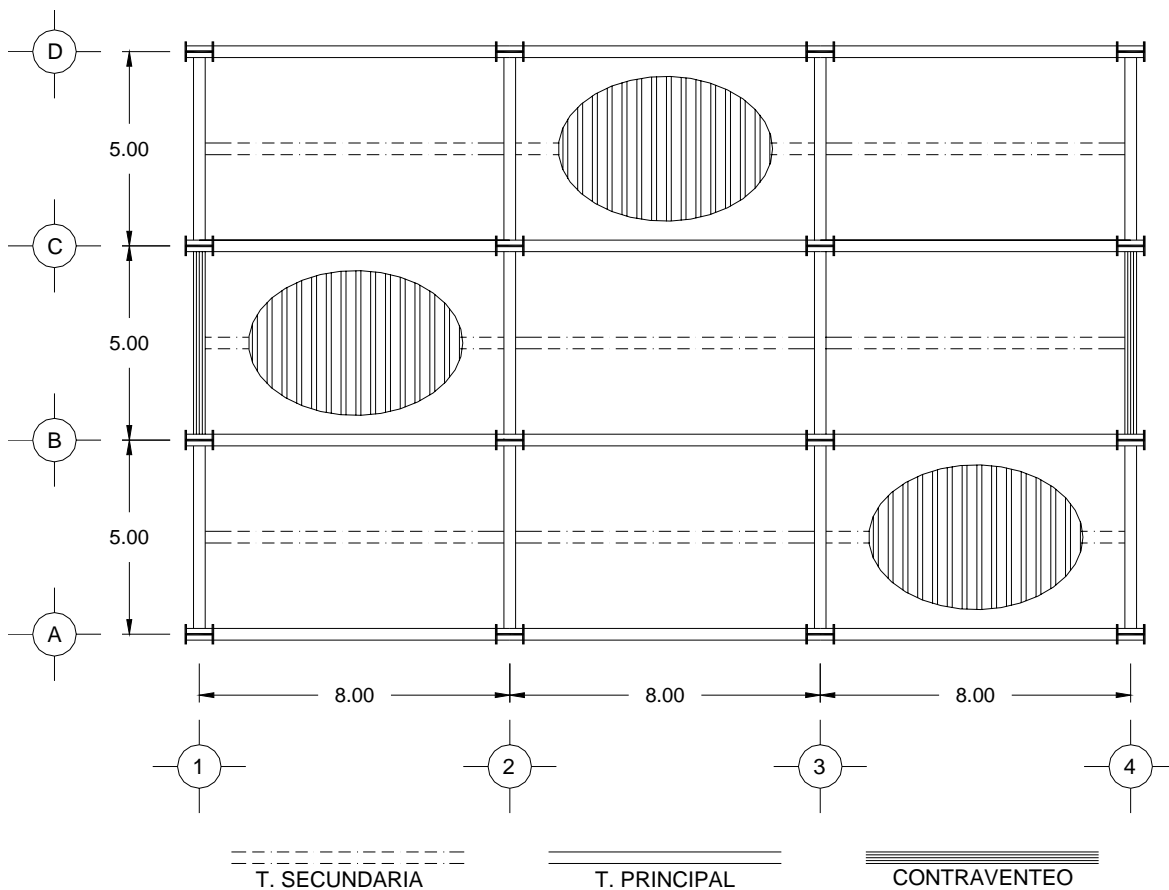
Planta estructural de los edificios (acotaciones en metros)
